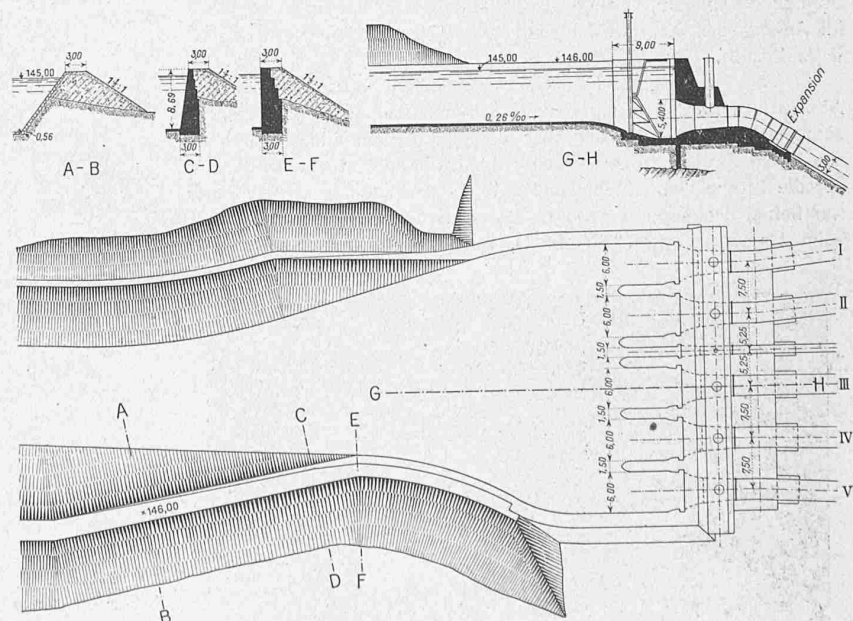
Das Wasserschloss am Kanalende. — Grundriss und Schnitte 1:1000.
